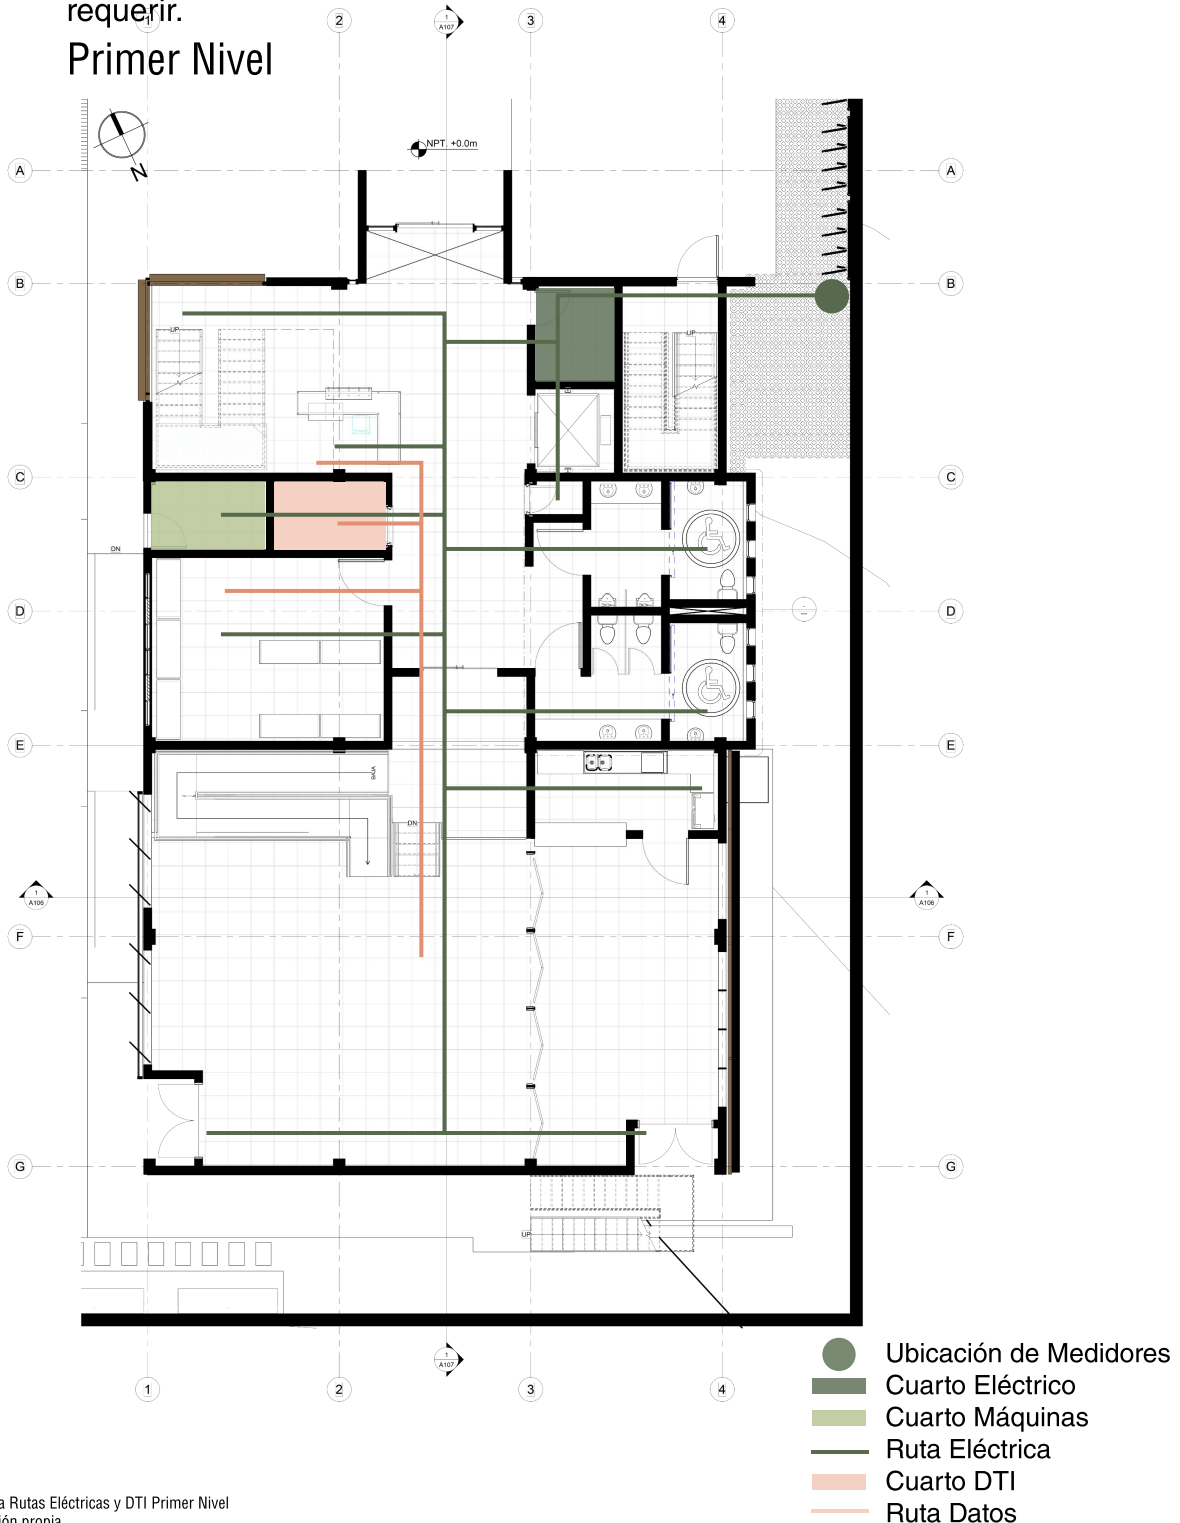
Planta Rutas Eléctricas y DTI Primer Nivel
